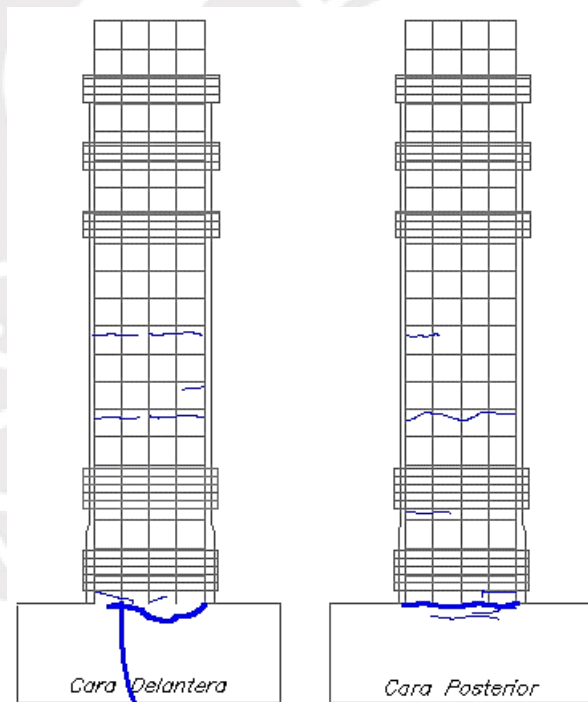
Mapa de fisuras de la viga VM-03
